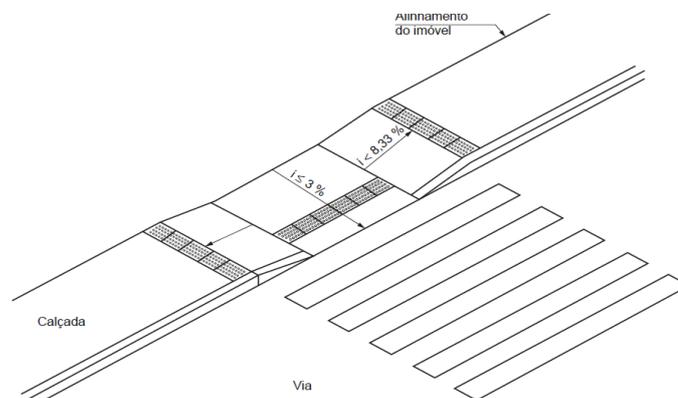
Rebaixamentos de calçada entre canteiros – Vista superior
